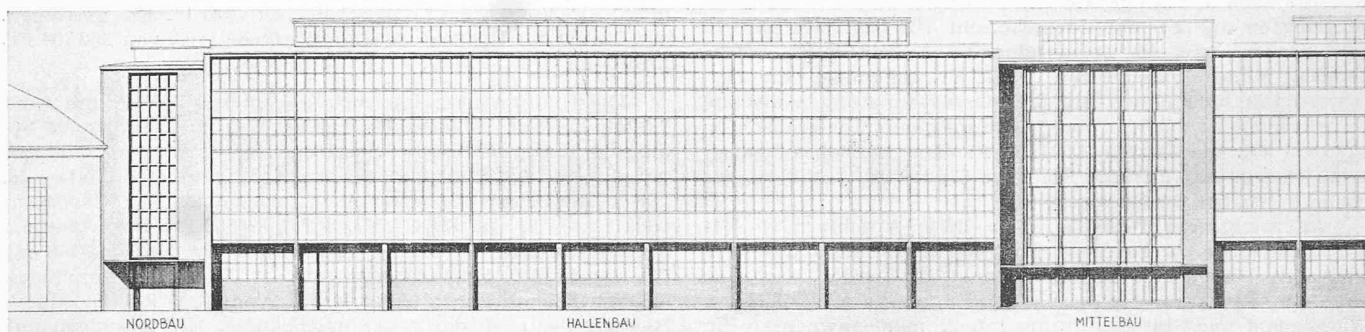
Grundriss der Obergeschosse; darüber (Bild 14) Fassade am Riehenring. Masstab 1 : 600
